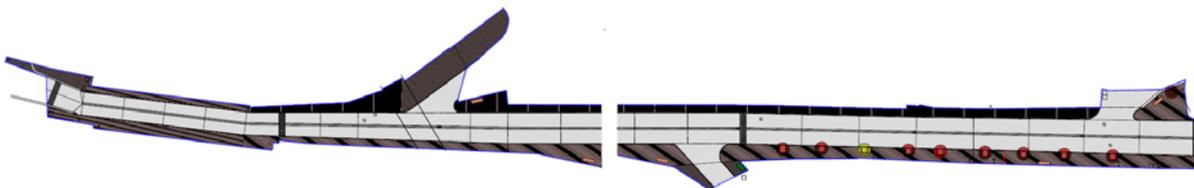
Plano de la pavimentación de la Av. Virgen de la Fuente
